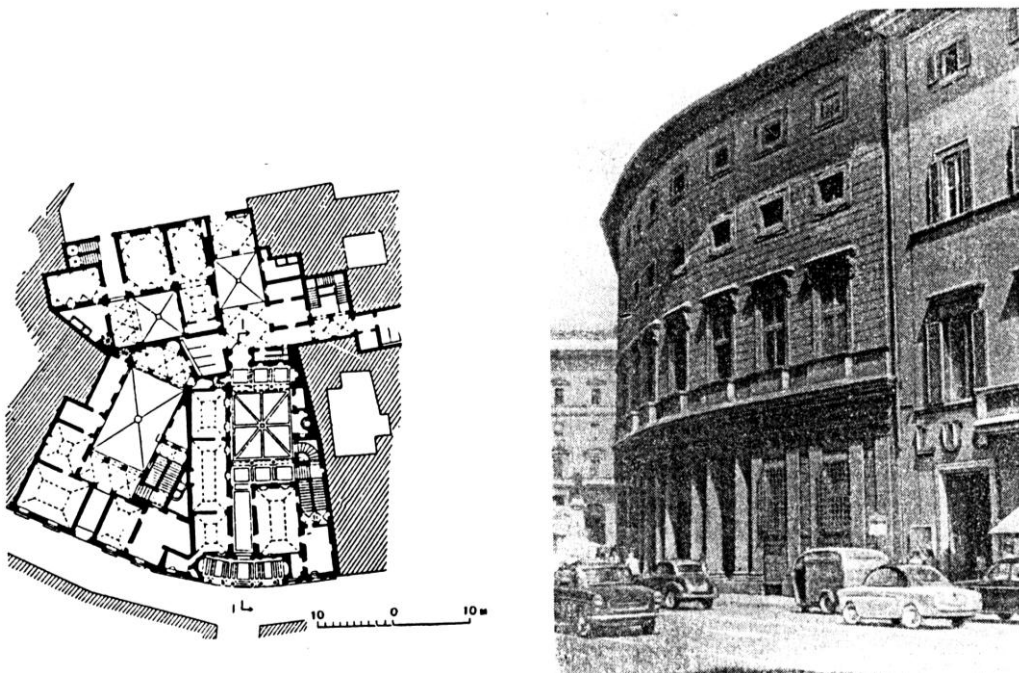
Рим. Палаццо Массими, с 1535 г. Архитектор Перуцци. План 1-го этажа. Фасад
